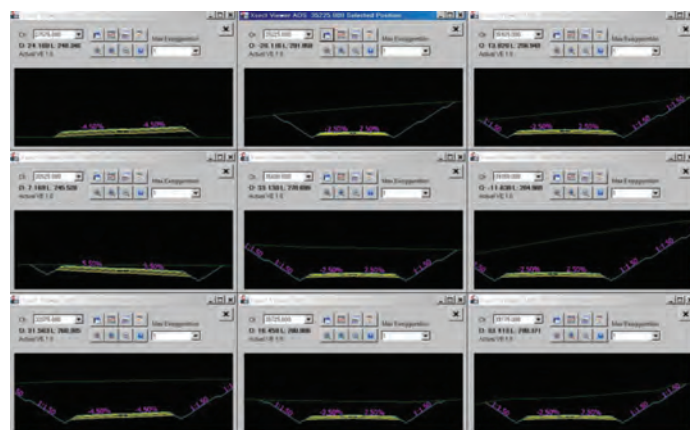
Ferestre multiple de vizualizare secțiuni transversale curente
